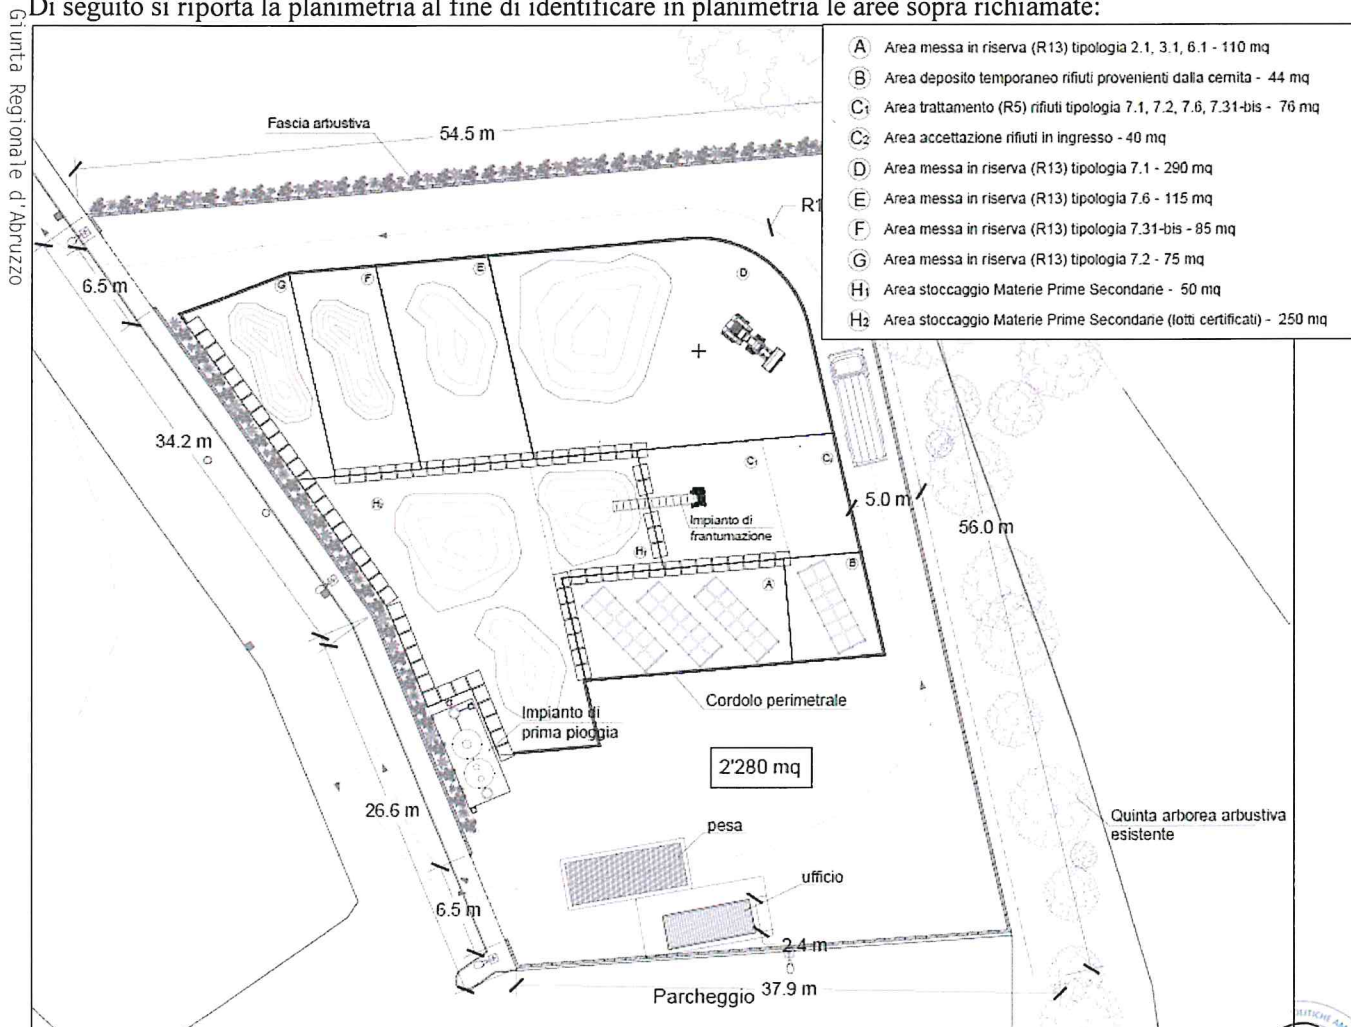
Layout impianto (da "B_layout impianto" allegata alla VP)
